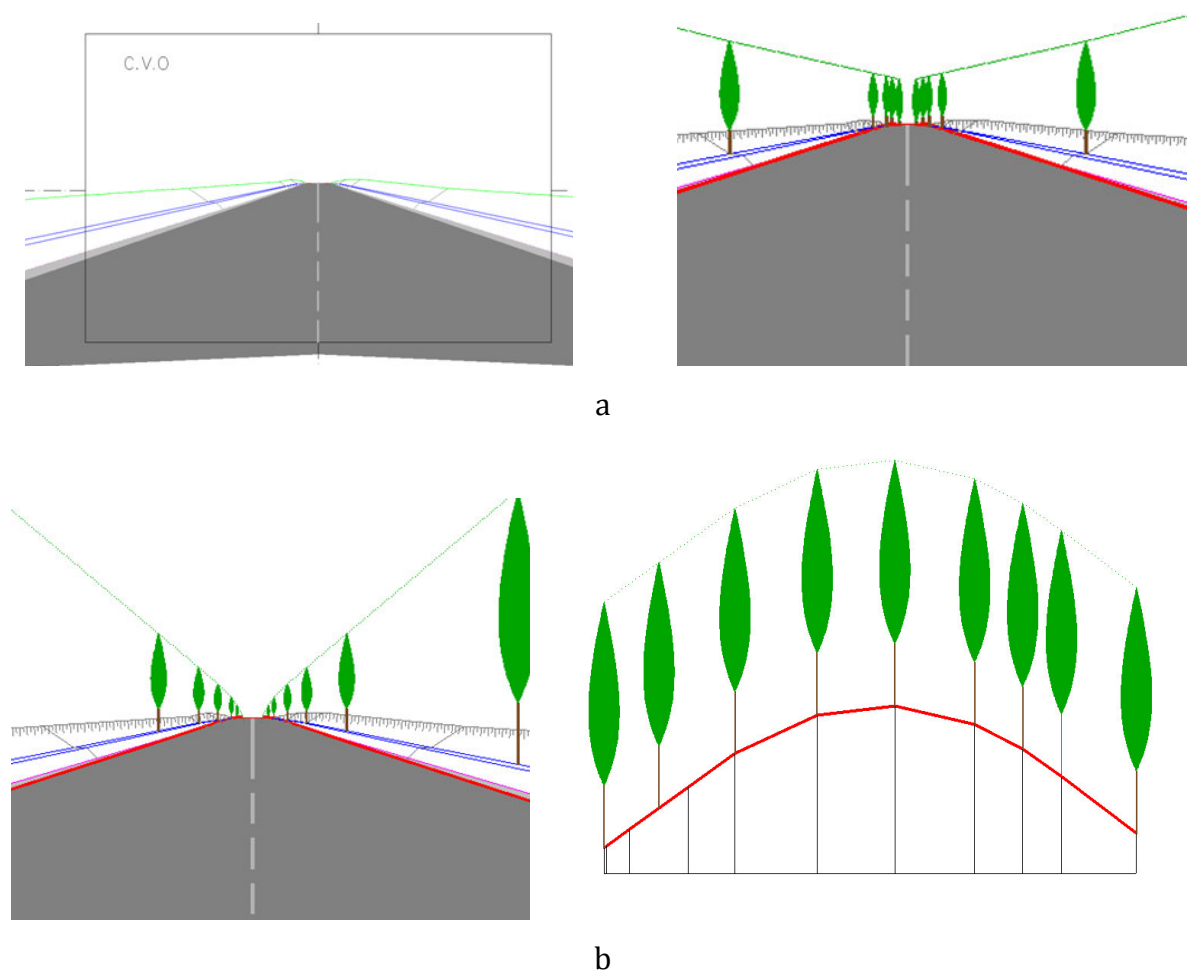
Amenajare plantații în vârf de pantă [168]
